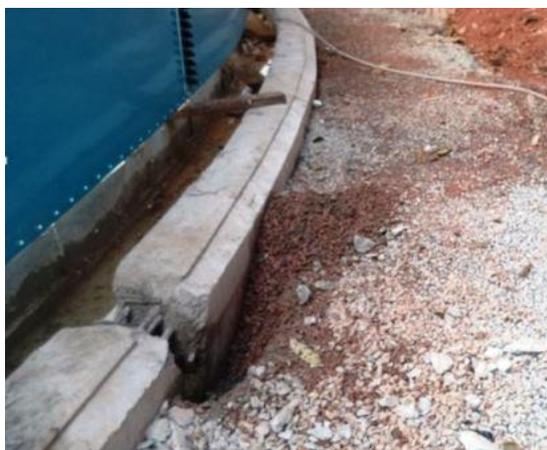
e 13 – Dificuldade: execução das formas para concretagem única da laje de fundo com canaleta
